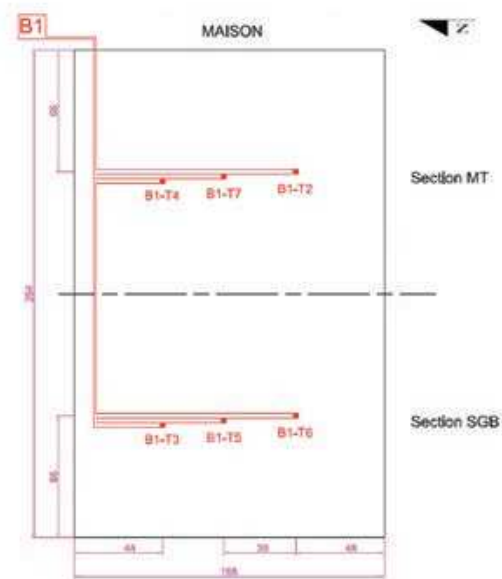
Emplacement de la maison, sections, thermocouples, conduits et boîte au 67, Croissant Roxton dans Montréal Ouest (les cotes sont en pouces).
